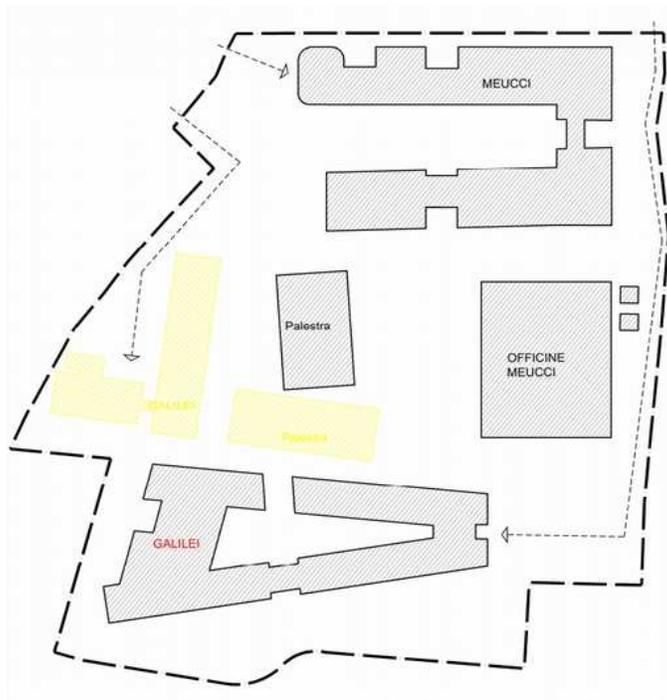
Schema FASE 4a demolizione Istituto Galilei
